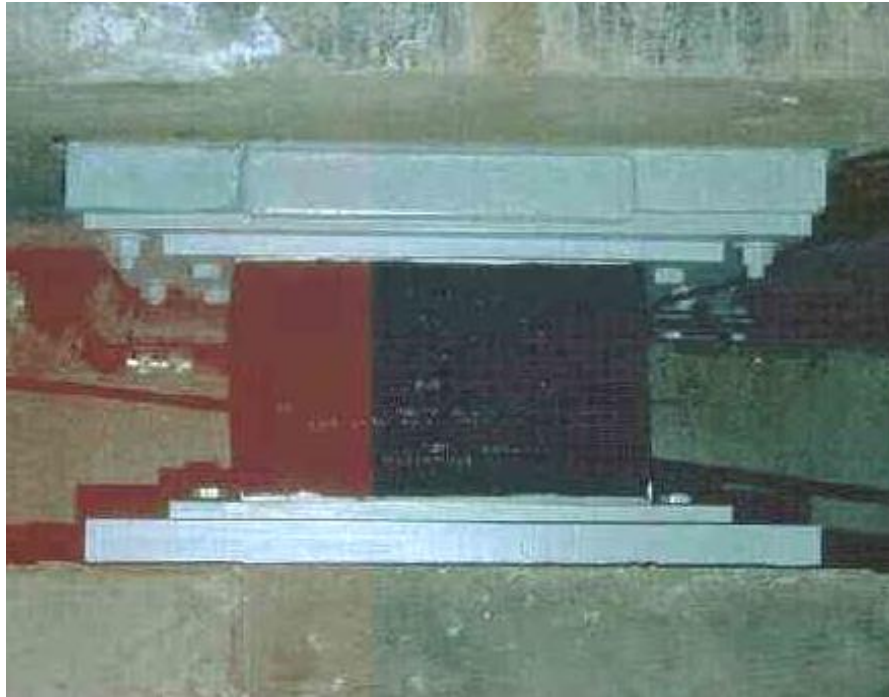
Aislador bajo la estructura del hospital anterior.
